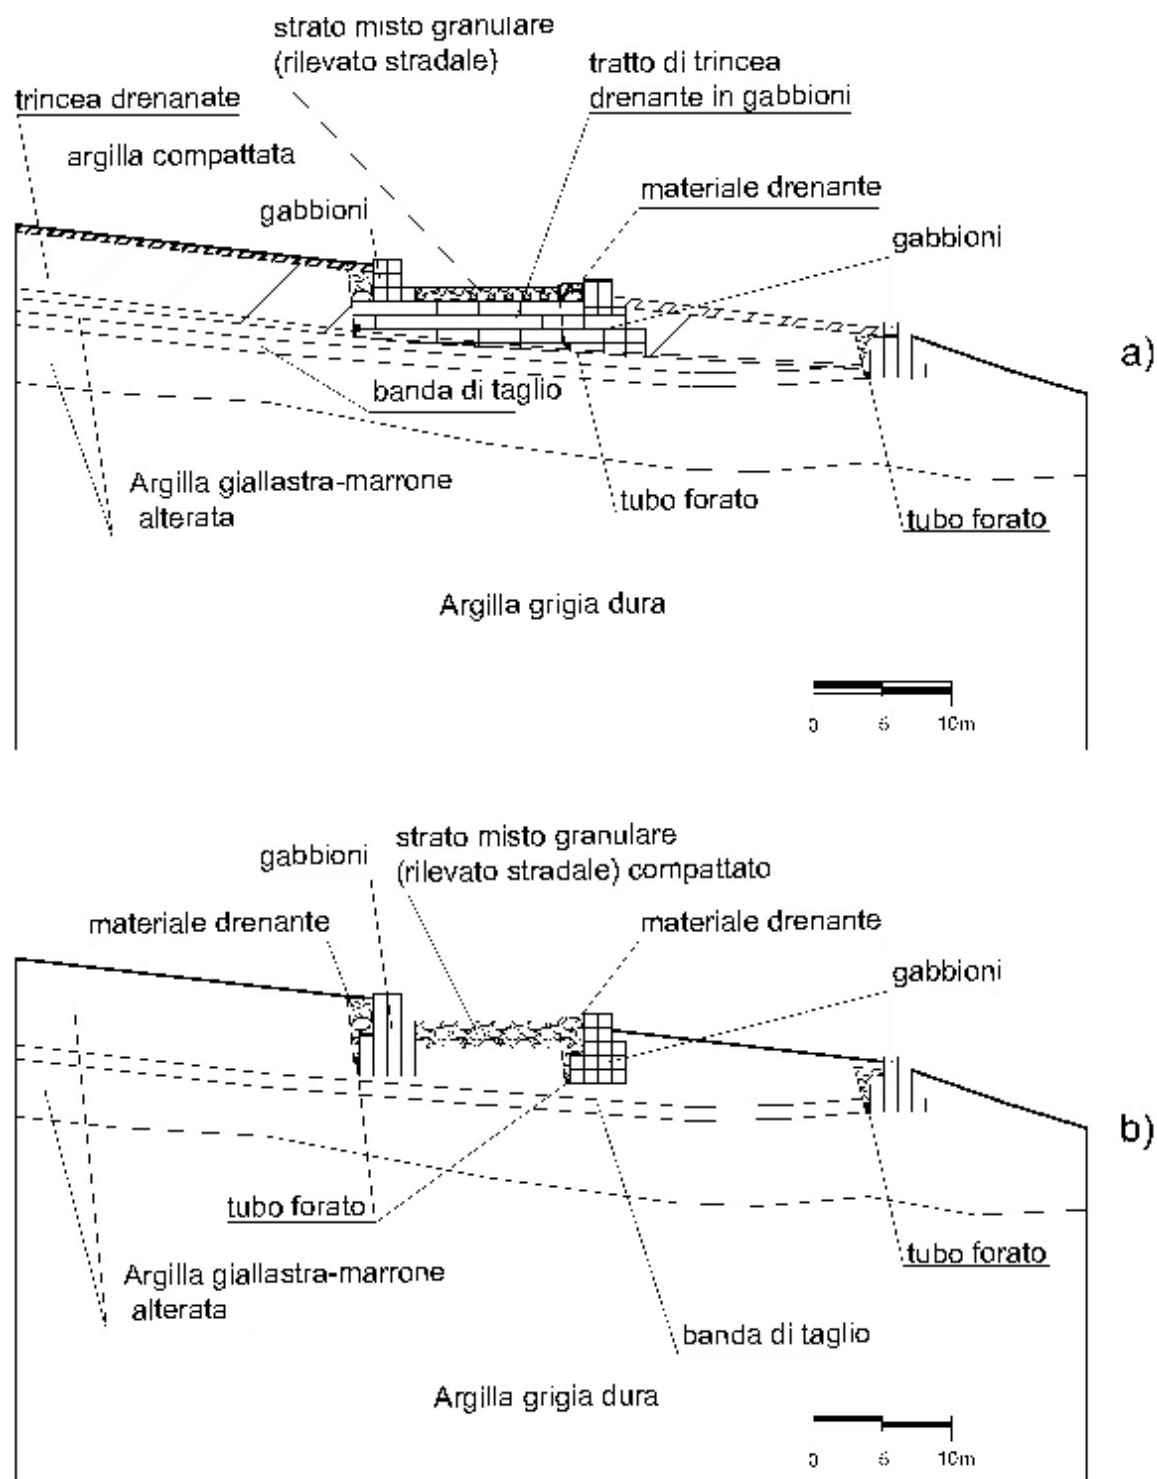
Dissesto al km 22+700. Sezione schematica degli interventi di consolidamento. Particolare in corrispondenza della strada. A) sezione in corrispondenza di una trincea drenante; b) sezione fra due trincee drenanti.
